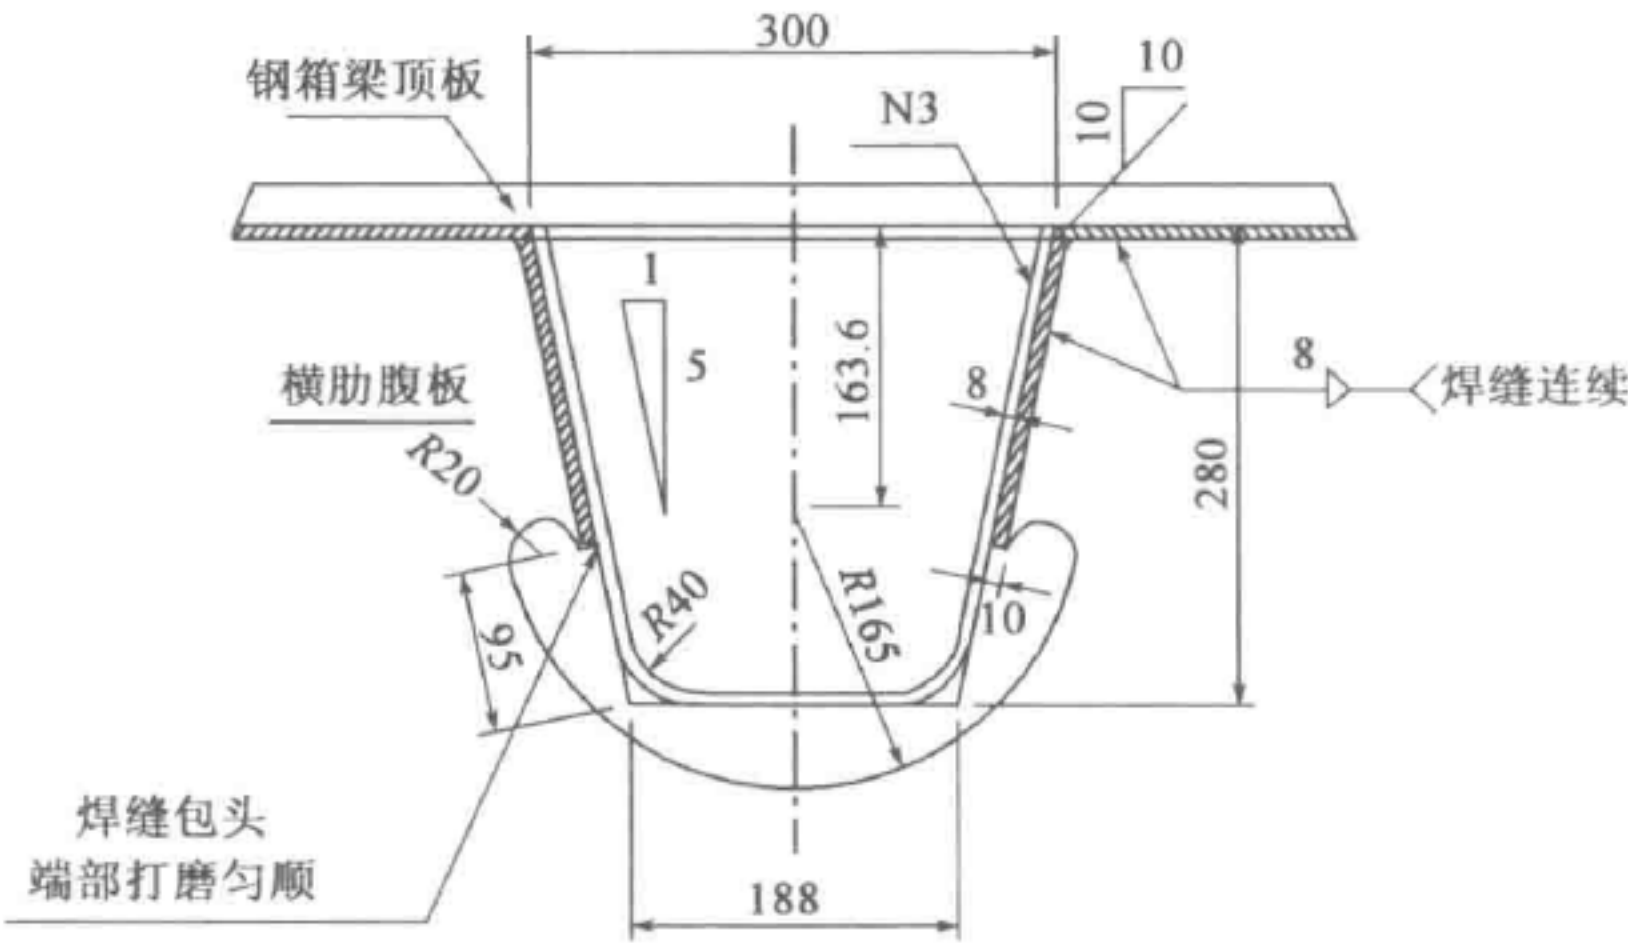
顶板 U 肋及通过孔构造(尺寸单位:mm)
